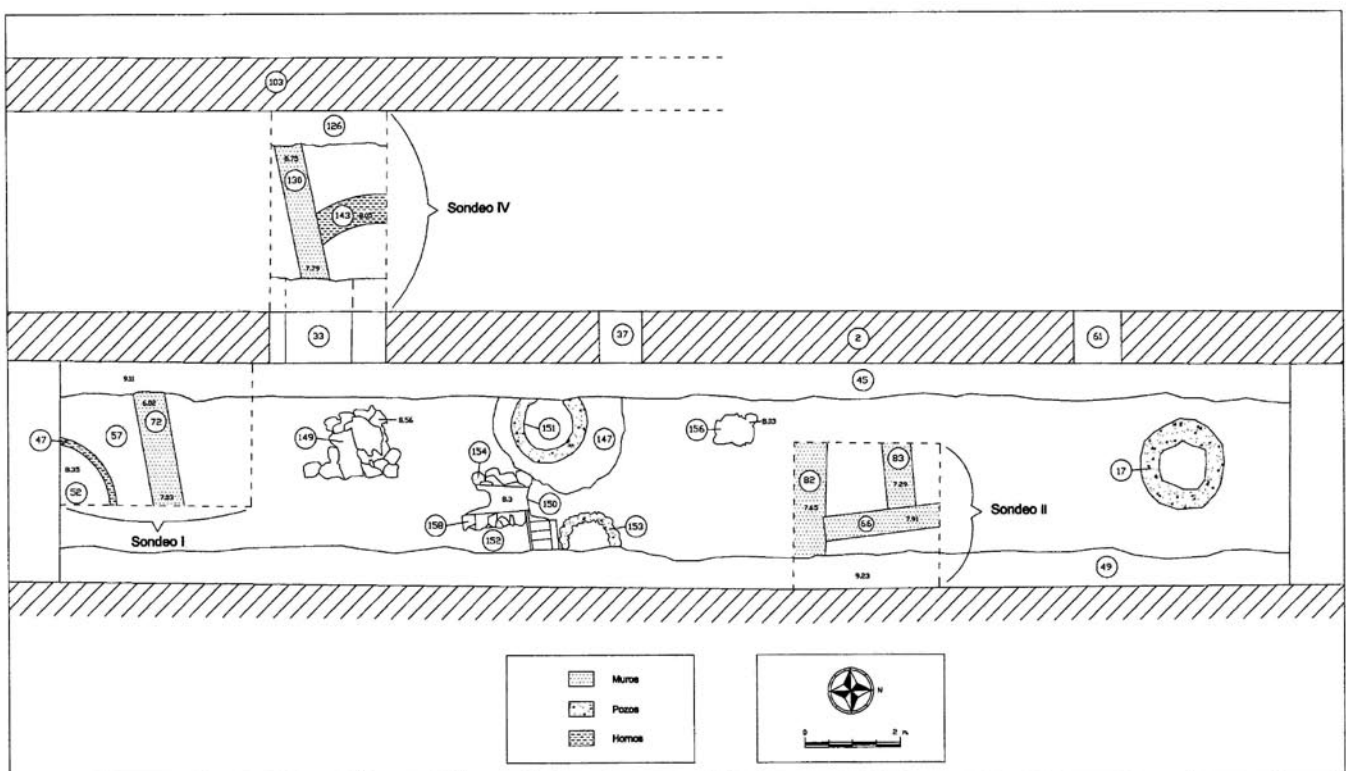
Planta general de sótano y estancia 3 con estructuras aparecidas en excavación y vigilancia general de movimientos de tierra.
